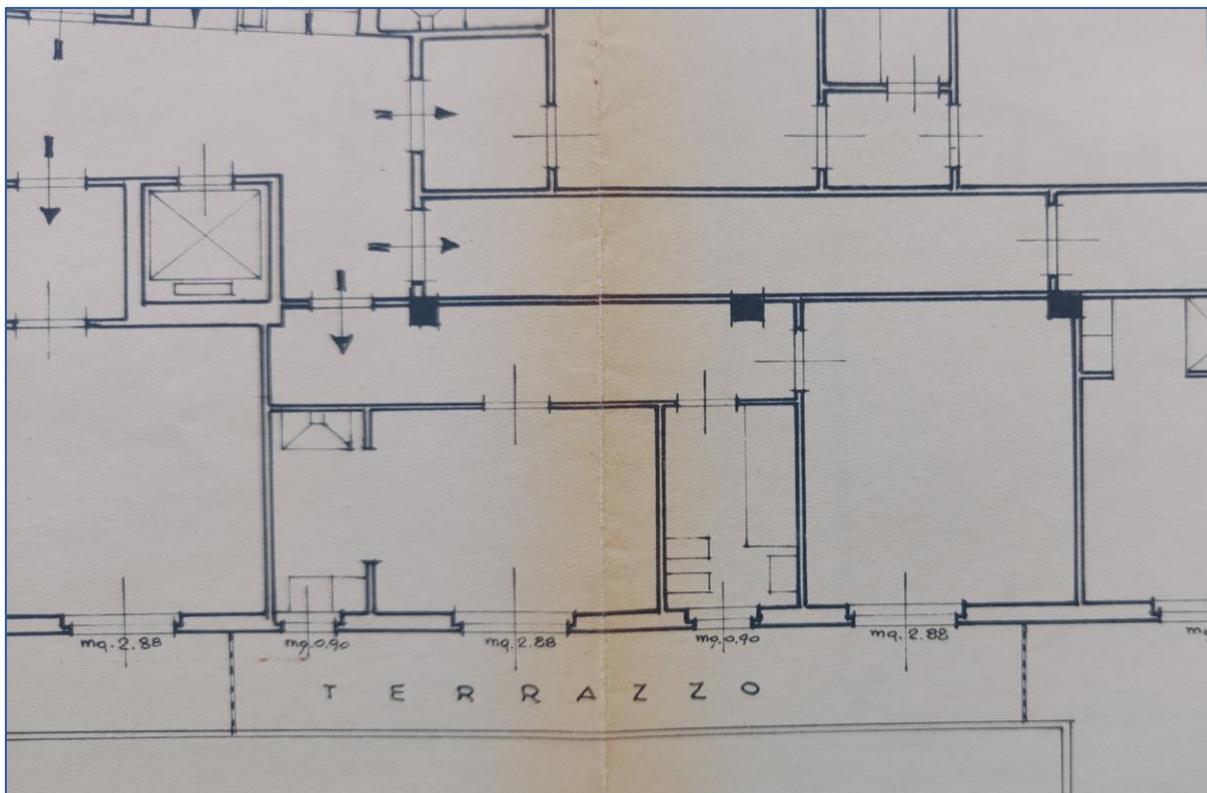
Estratto tavola di progetto Licenza Edilizia n. 171/1958
